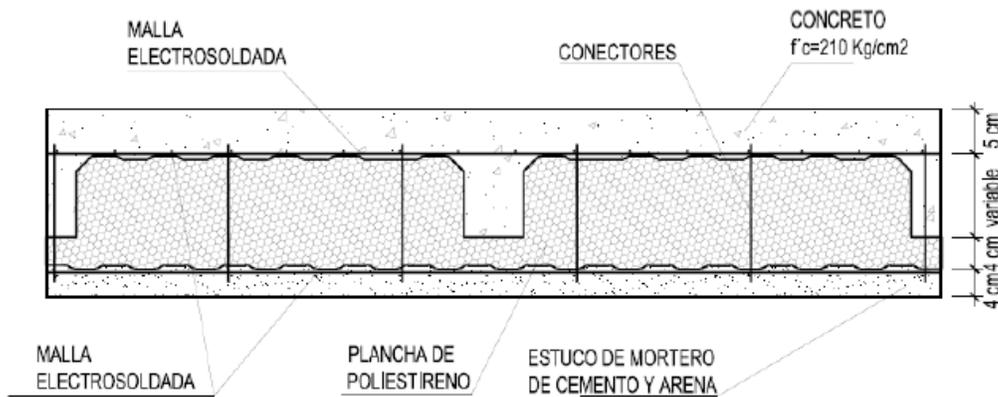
Panel losa con dos nervaduras para armado de viga (PL3).
